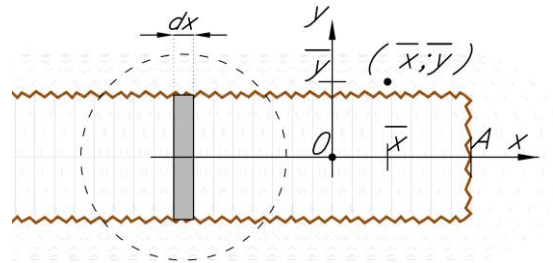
Vista in pianta della galleria in costruzione. Dominio bidimensionale per la stima dei cedimenti
